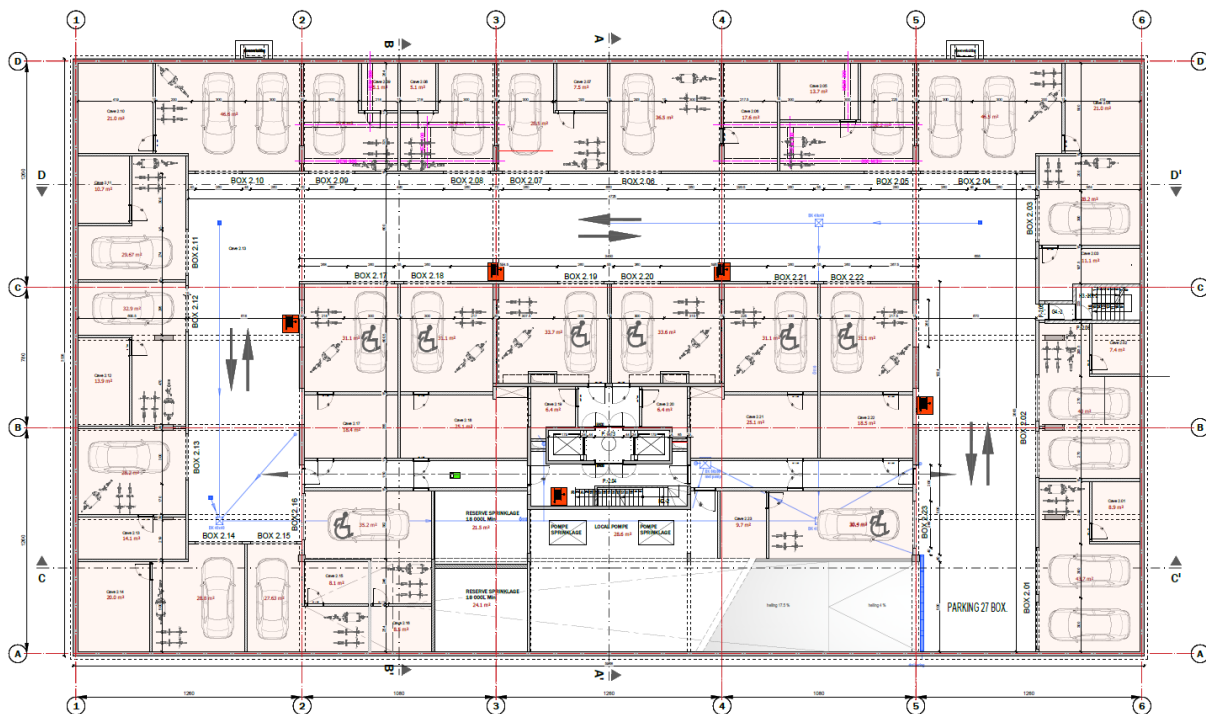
Extrait de plan du R-2 (source : ARTER Architects)
